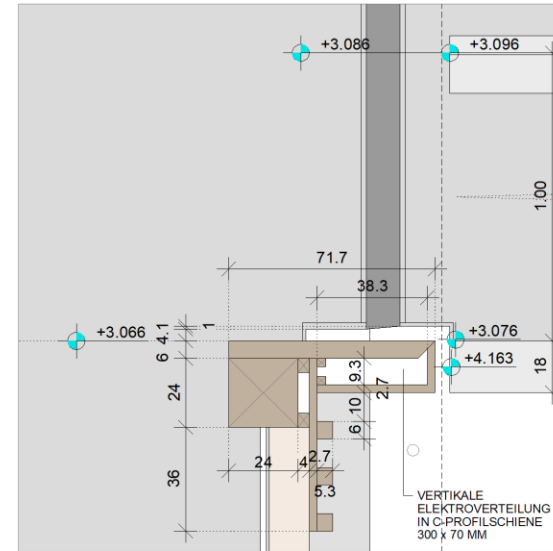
DETAIL RAMPENÜBERGANG (BILDRECHT B&O GRUPPE)
